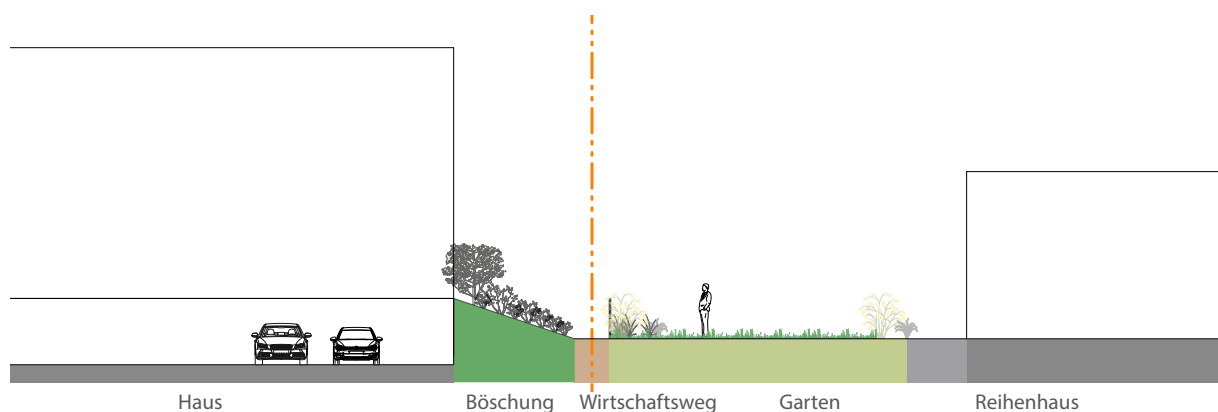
// Systemschnitt Sockel schließt mit Gebäude ab und wird mit Böschung ergänzt
